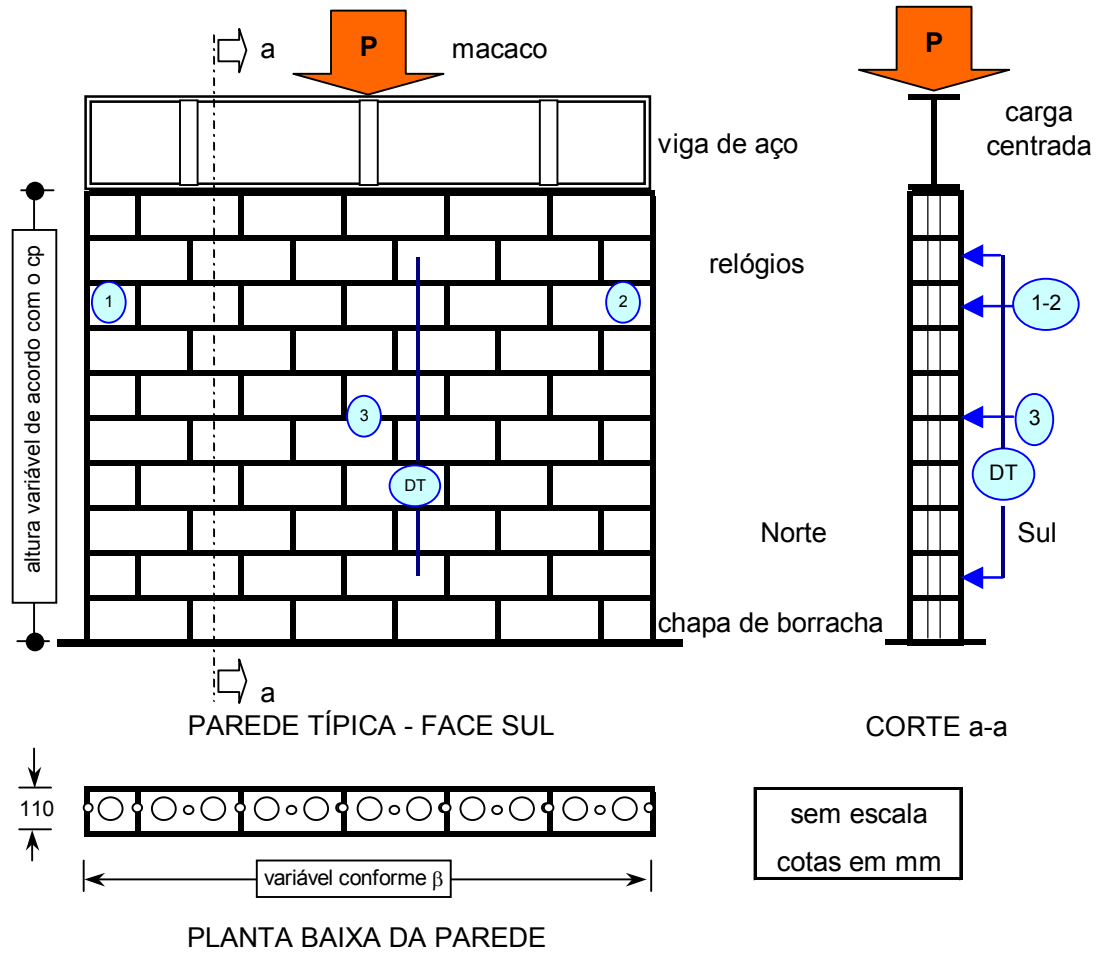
Parede típica – face sul , planta baixa e corte a-a
